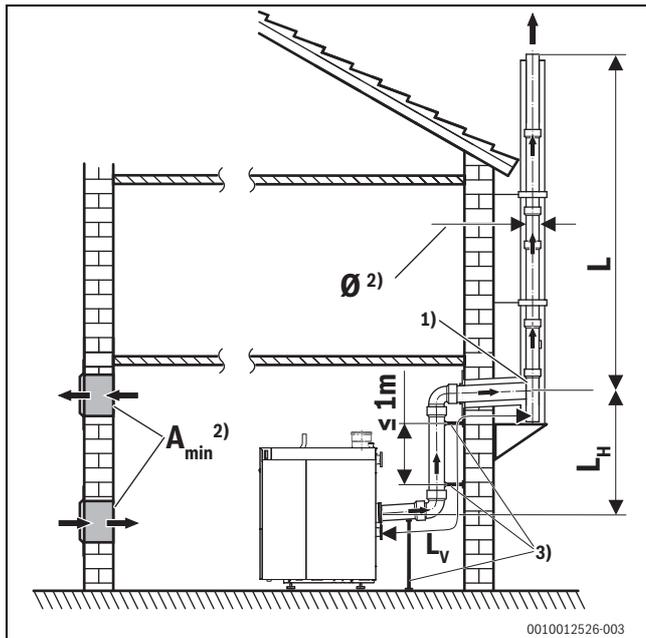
Évacuation des fumées sans conduit, système sur façade, variante 4
